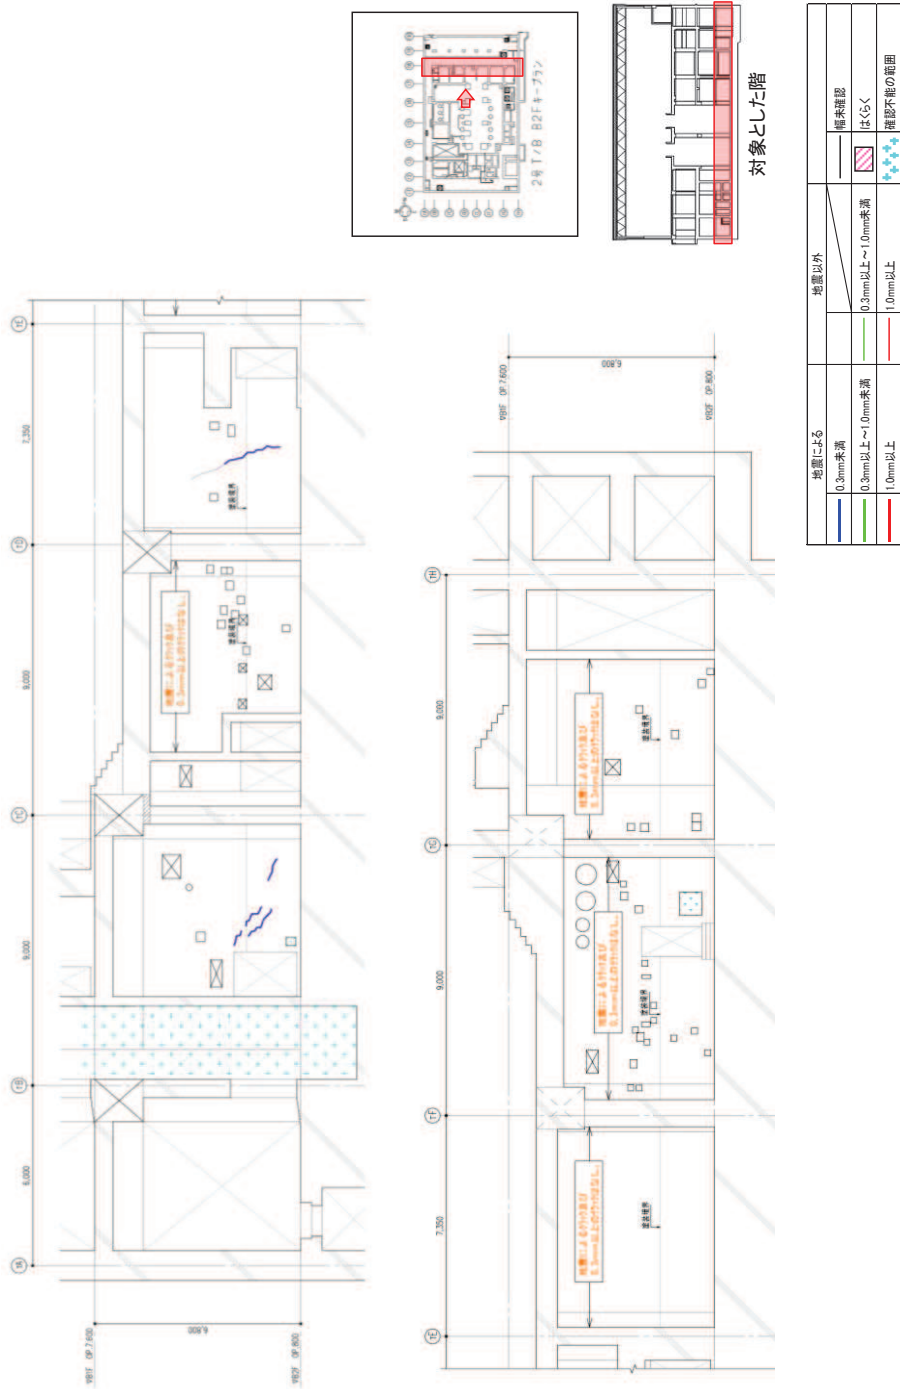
タービン建屋のひび割れ分布 耐震壁 (8) 地下2階 T8 通り
